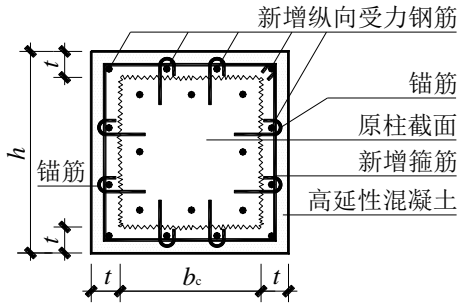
高延性混凝土围套加固钢筋混凝土柱示意图
